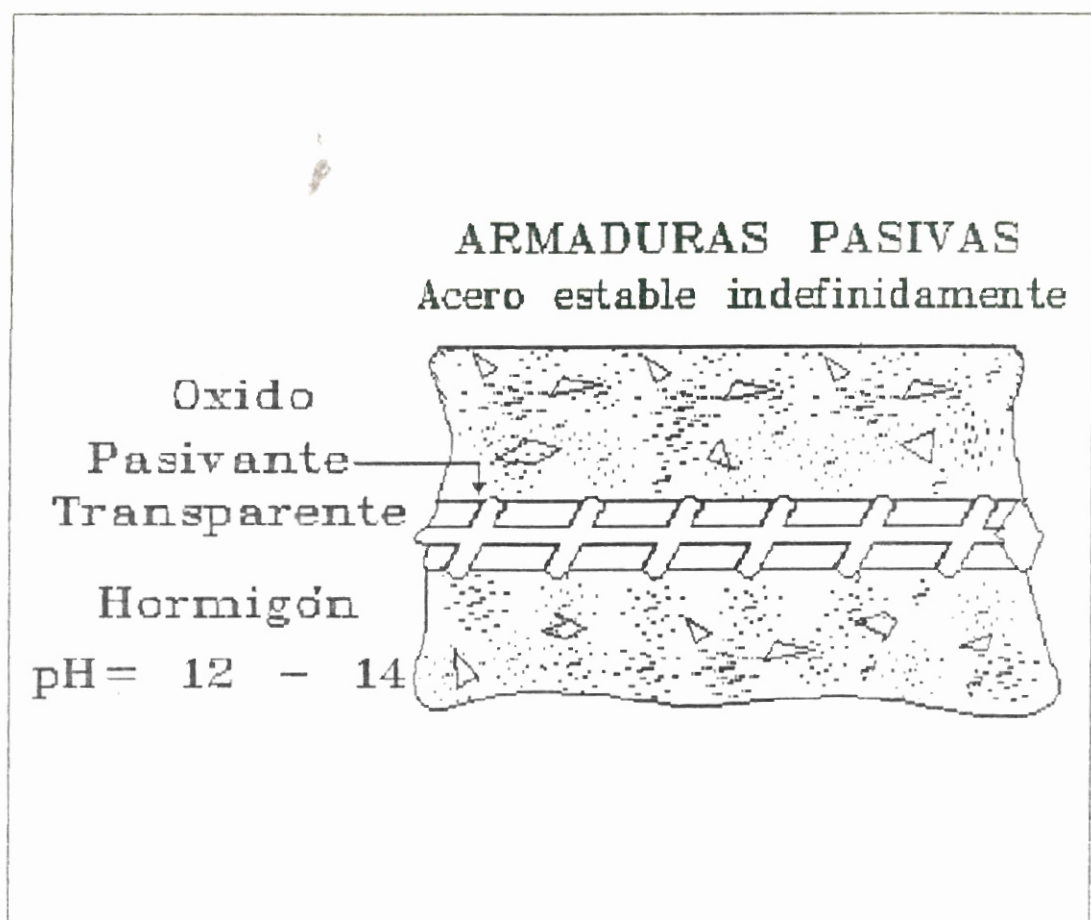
Armaduras embebidas en un hormigón sin contaminar.
